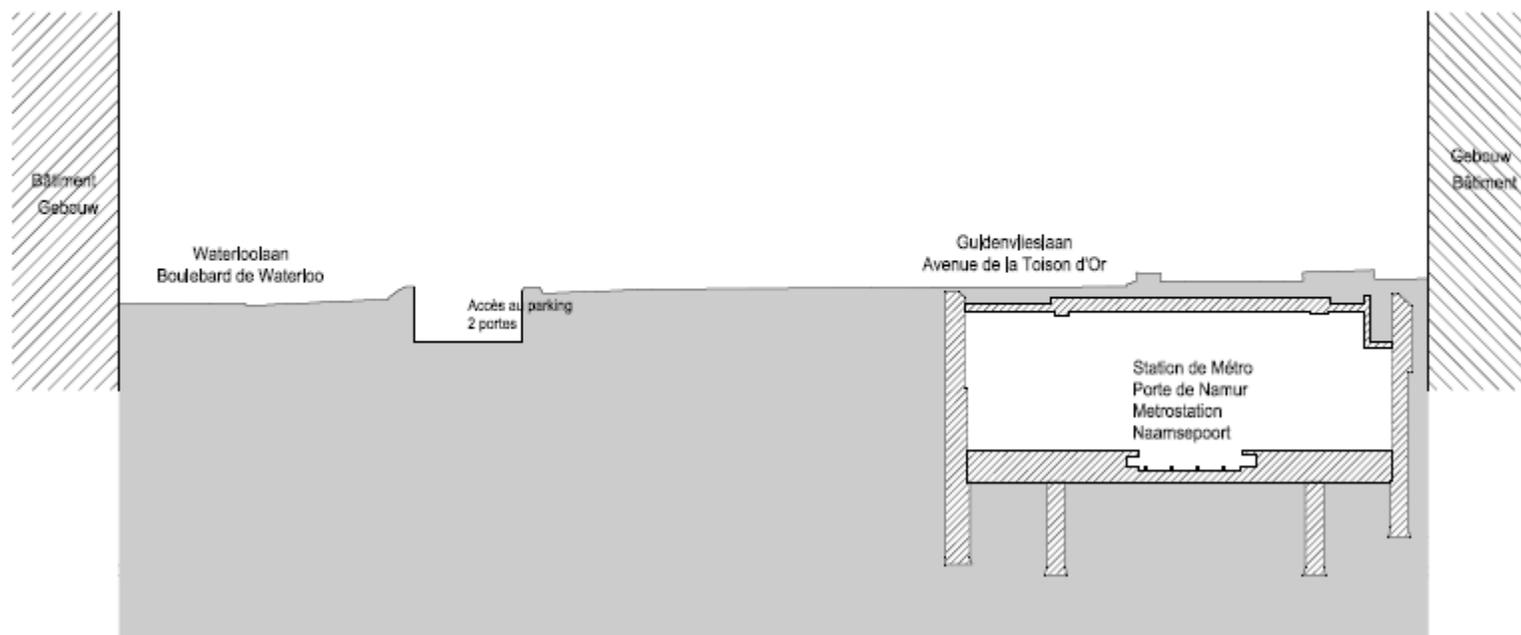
Coupe transversale 7 de la zone du projet dans la situation existante.
